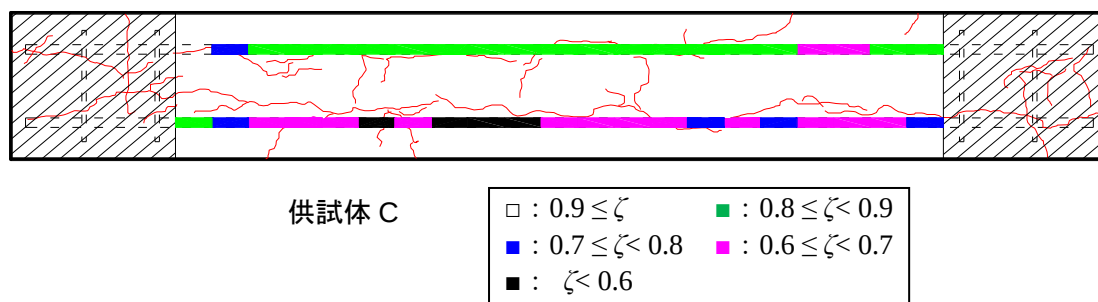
ひび割れ幅計測に基づく鉄筋とコンクリートとの付着力比の推定値の分布
